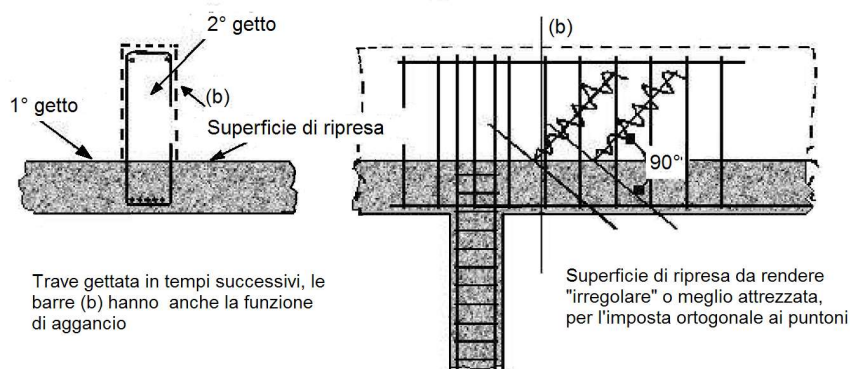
Modalità di ripresa del getto su travi di spessore elevato
